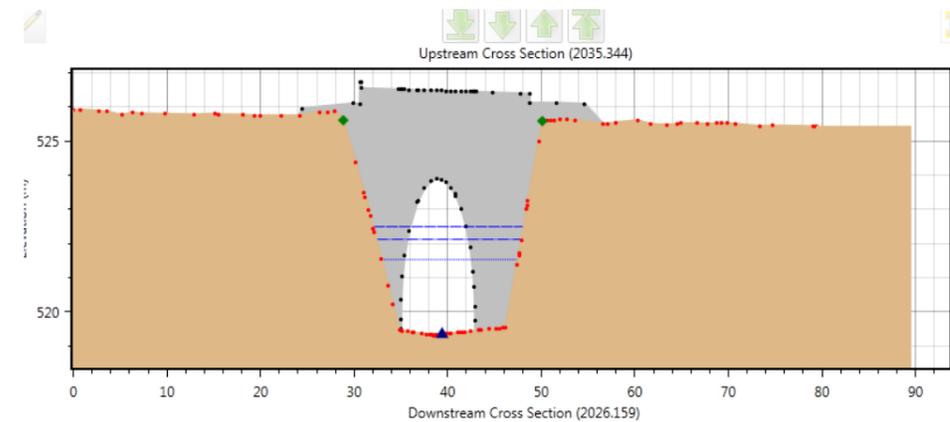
Niveles río Errekaleor en obra de cruce existente. Fuente URA.
